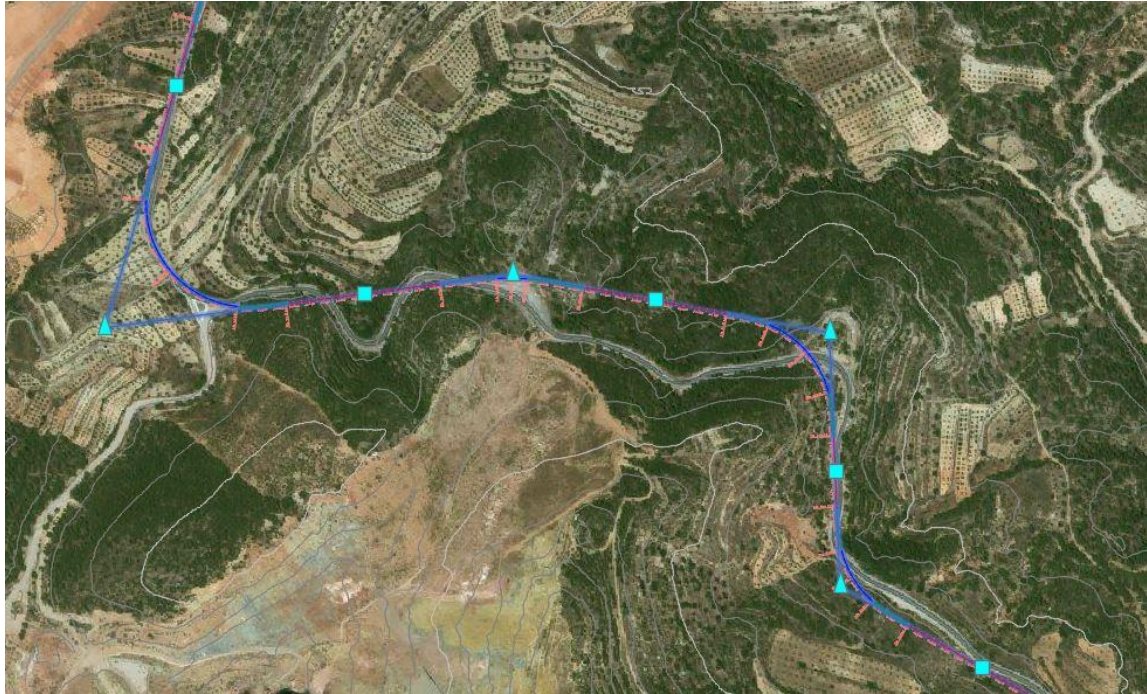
Propuesta de trazado en planta, curvas 14, 15 y 16. Fuente, CIVIL 3D.
